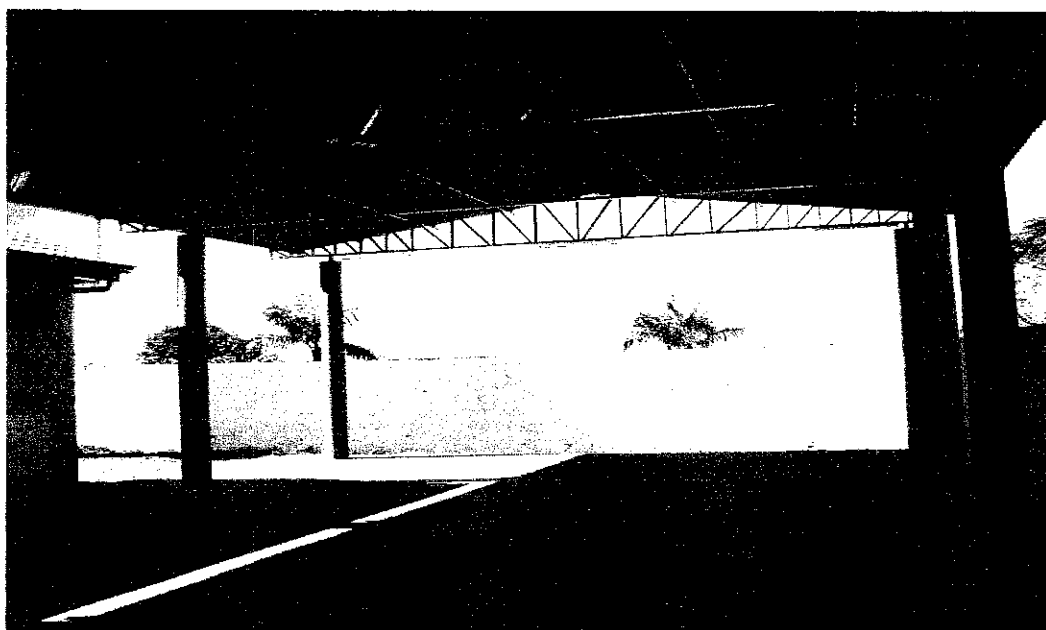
Vila Nova Teotônio. Pátio da escola, que vem sendo utilizado como quadra de esportes, apesar do cimento grosso.
